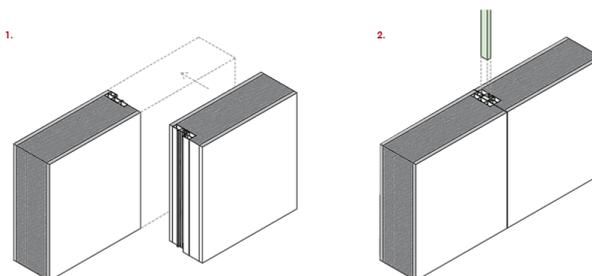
Encaixe e travamento entre painéis no mesmo plano
